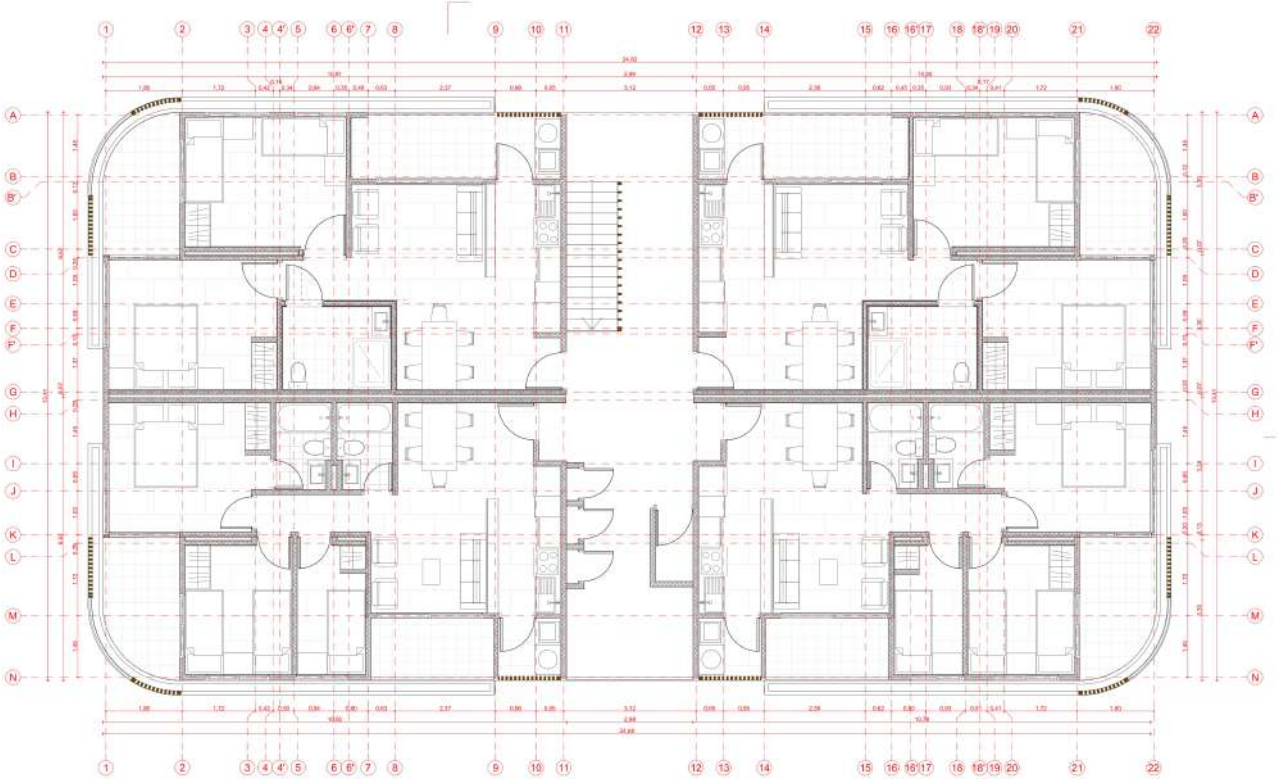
Planta de Arquitectura, Edificio Tipo 1.
